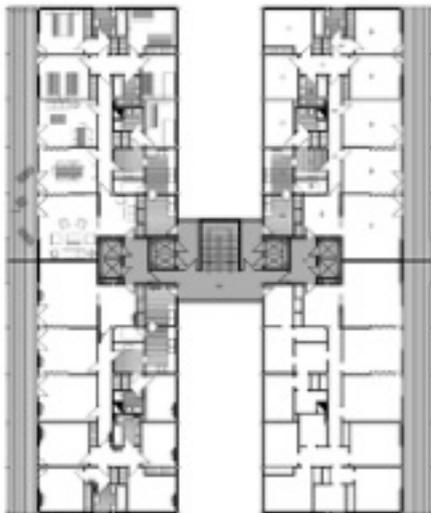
Planta del edificio de viviendas en la calle Justicia 1.
